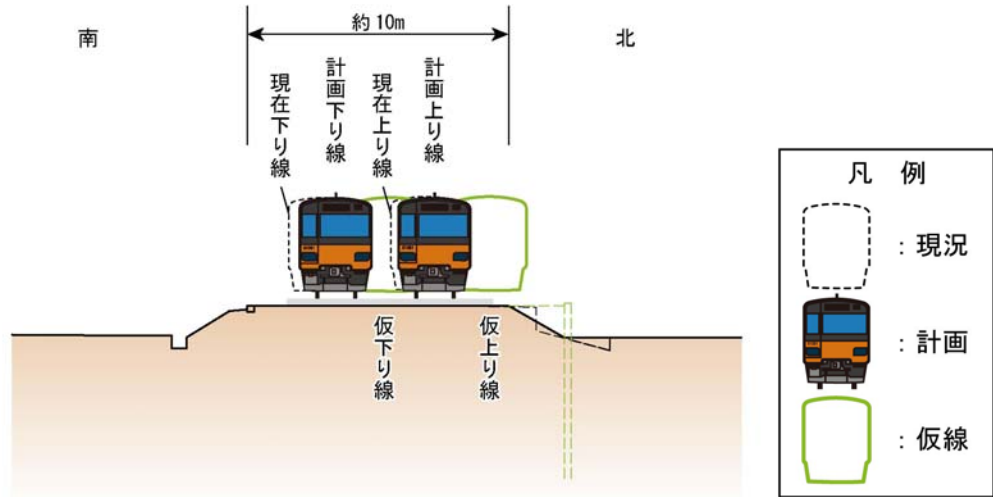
(3) 一般部標準断面図(地平区間(c-c断面))
